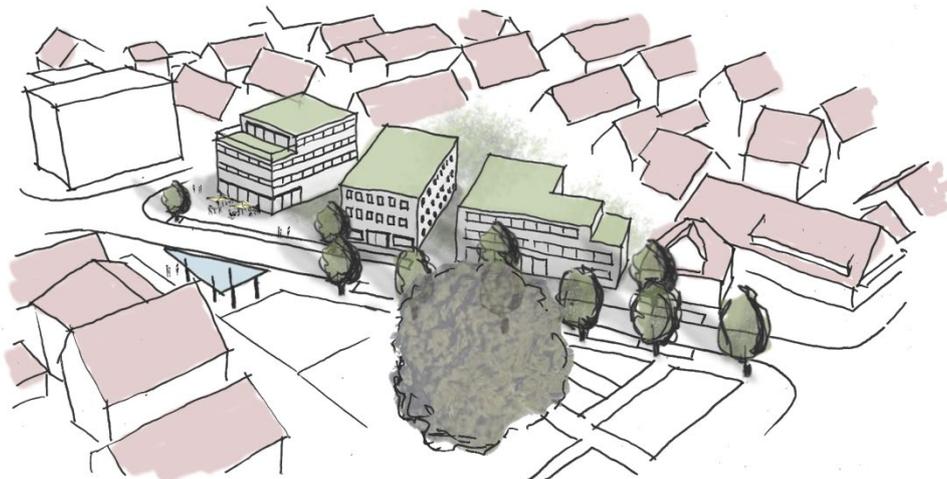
Ernst-Bauer-Platz Ostseite: Bebauung mit Gebäuden mit Flachdach
